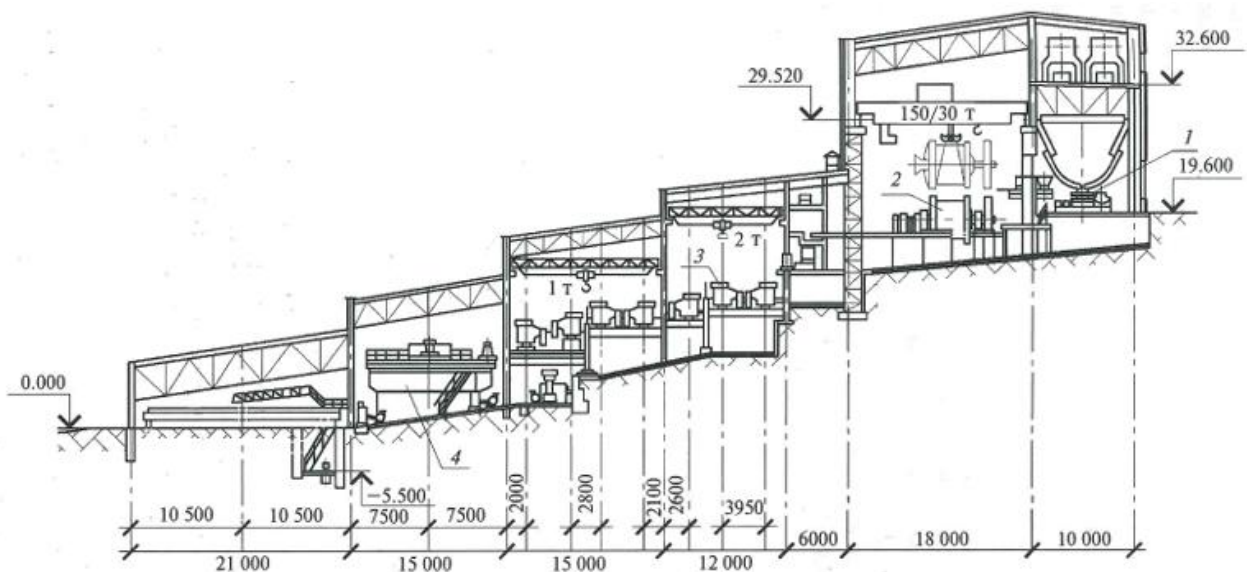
Головний корпус флотаційної фабрики з переробки поліметалевих руд:
